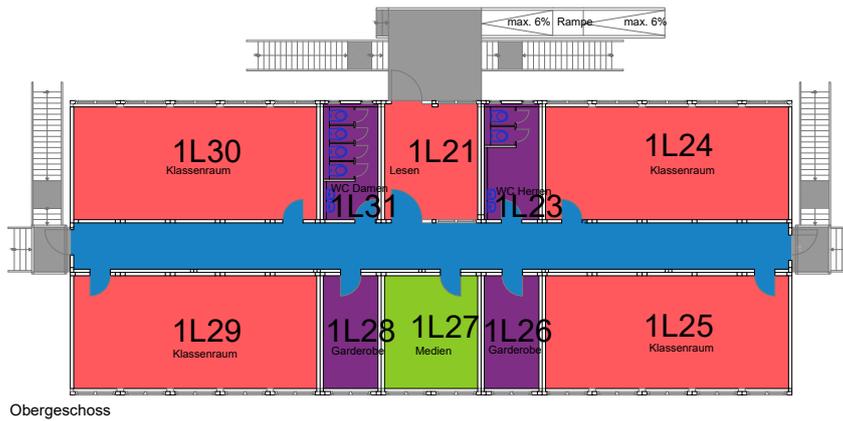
Hautgebäude, Obergeschoss (OG). Räume nach Nutzung eingefärbt
